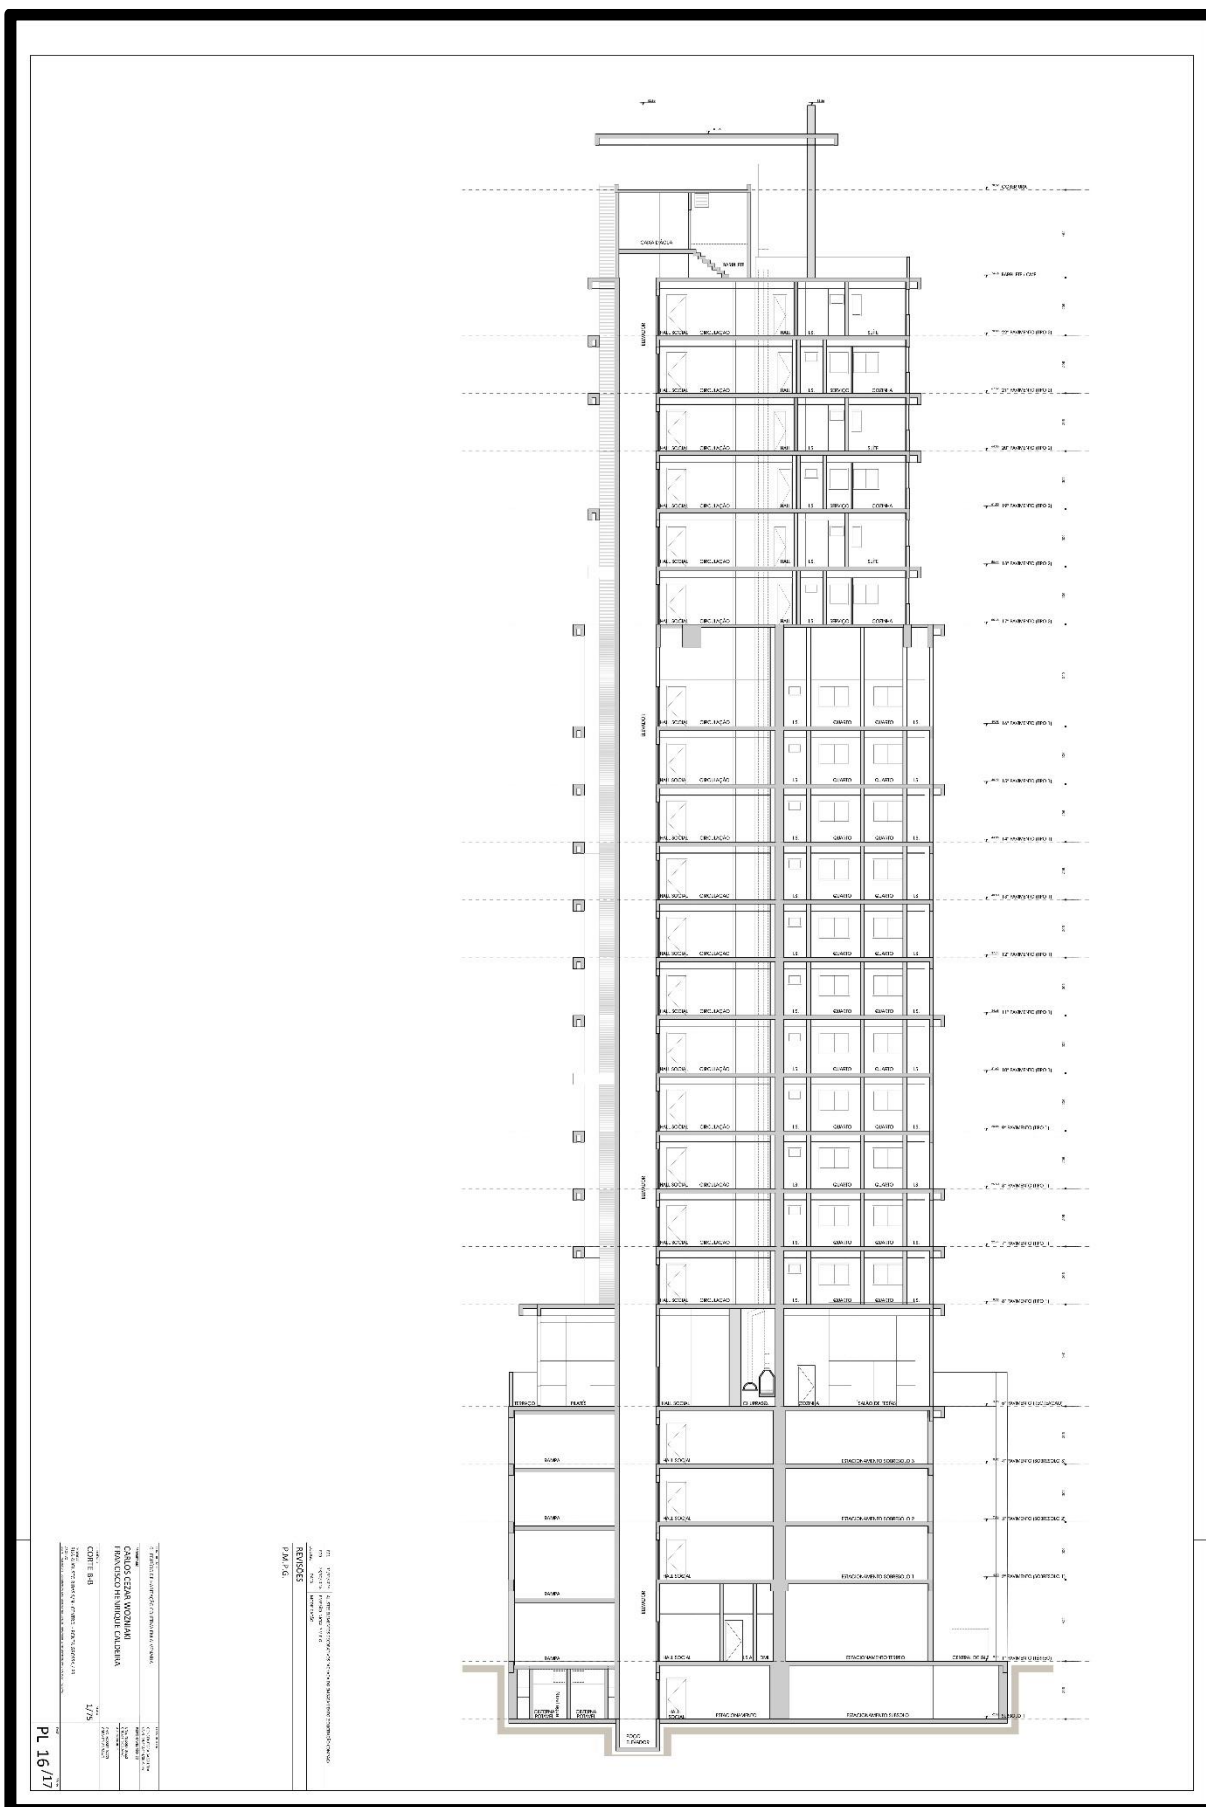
Corte B. Fonte: Construtora Bazzi (2020).
